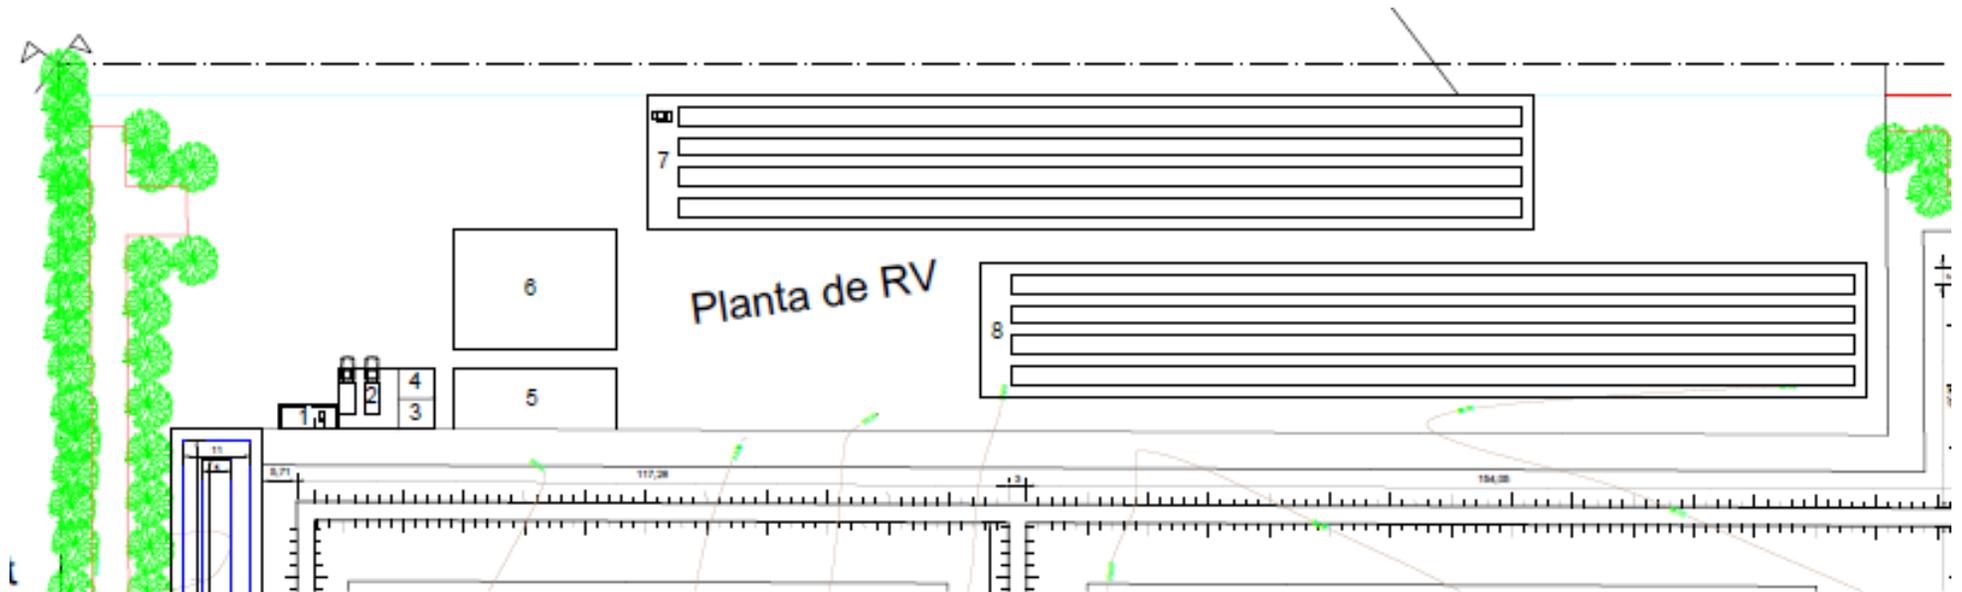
distribución general de estructuras de la planta de tratamiento de RV.
